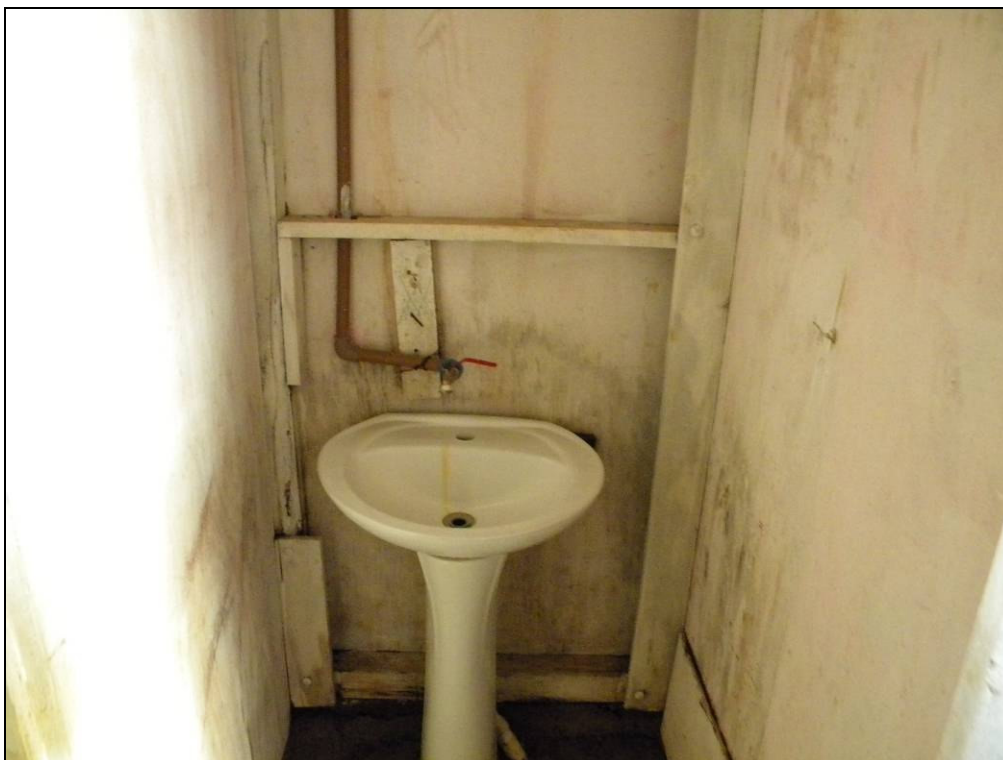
Banheiro da obra C (Obra Médio porte)
